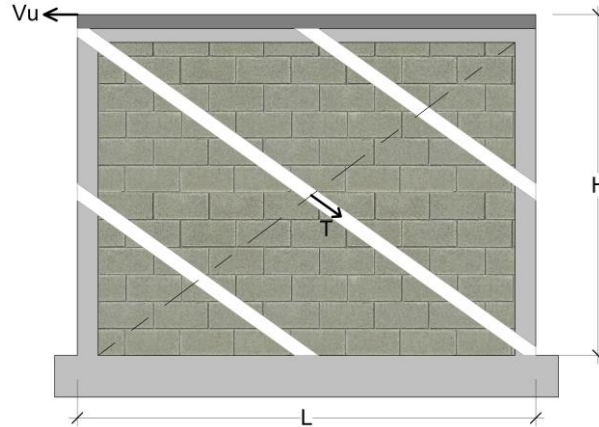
Distribución de bandas diagonales de GFRP en muro de mampostería.
